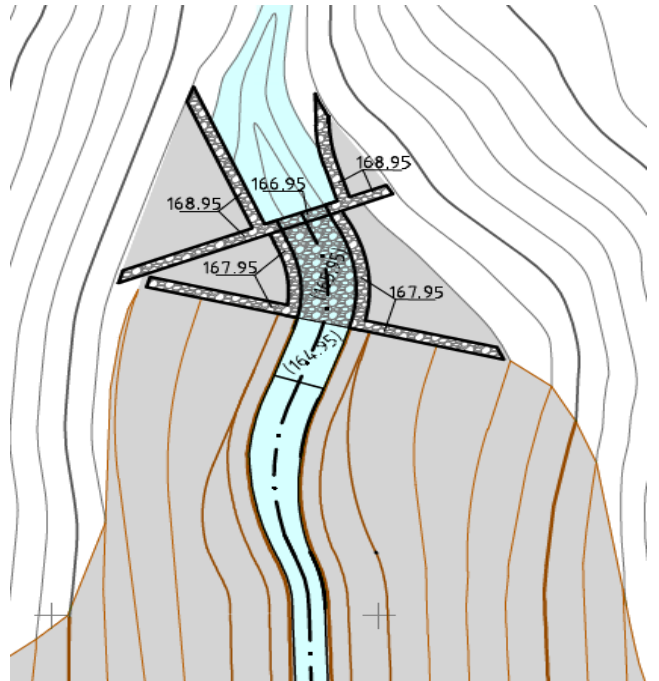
Planta da obra de ligação do Afluente ao canal 2.
